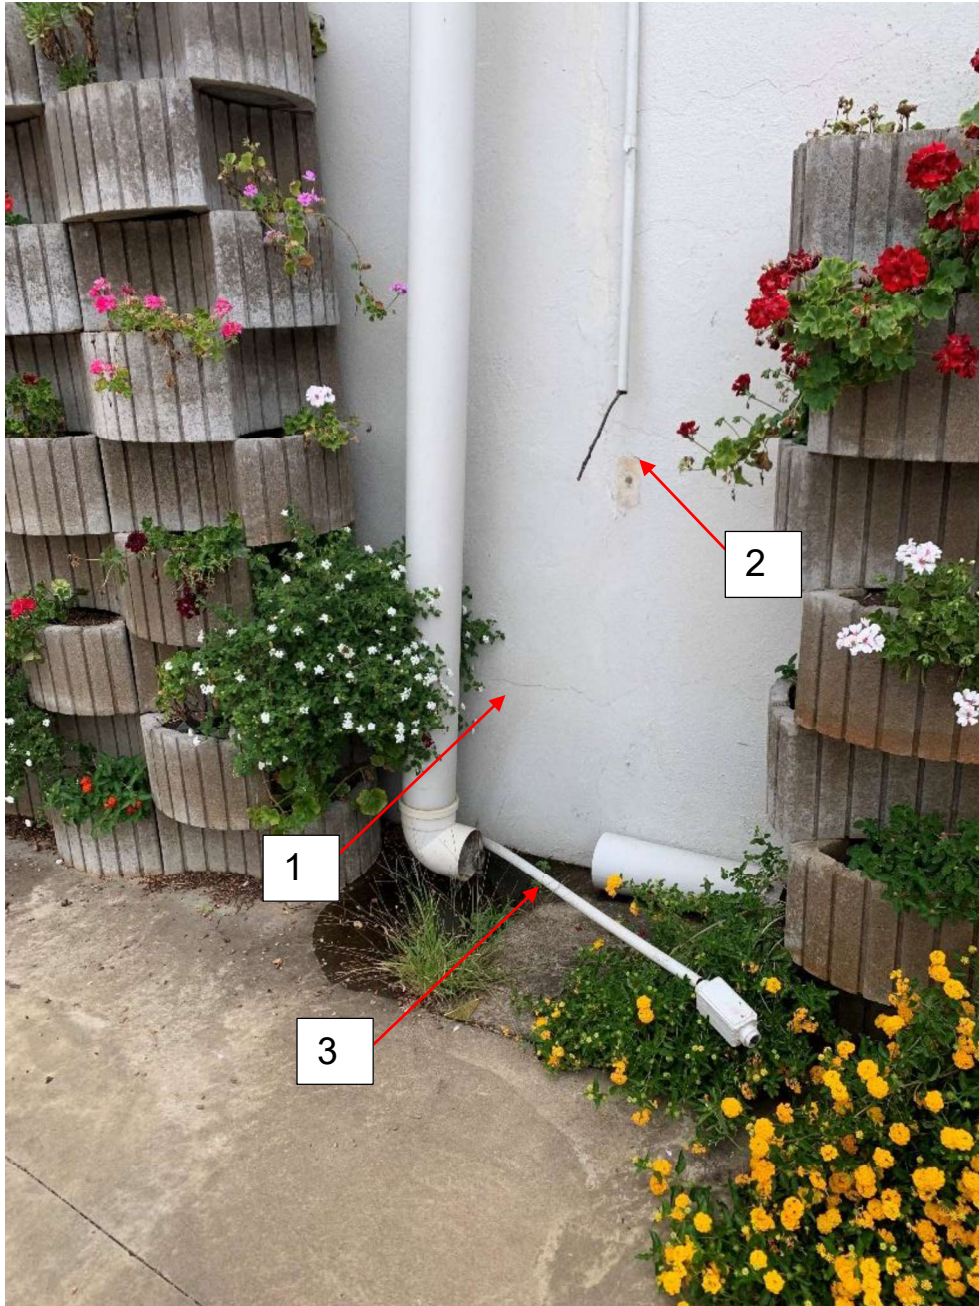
Vista externa, fundos da edificação, onde observa-se, fissuras na vertical, indicação 1. Sistema condutor do para raios (SPDA) rompido, indicação 2. Fissuras na horizontal, indicação 3.
